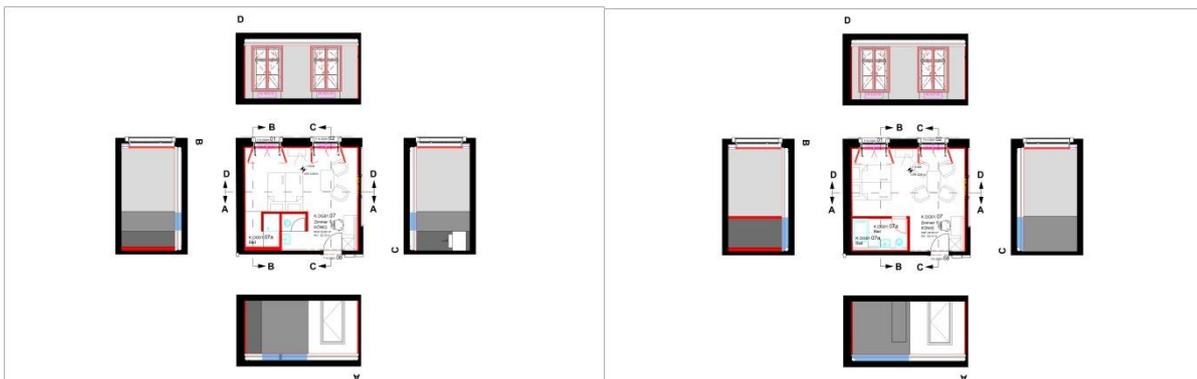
Grundrissvarianten mit Wandabwicklungen an der Innenwand angeordnete Badzellen, Architekten Keß und König
